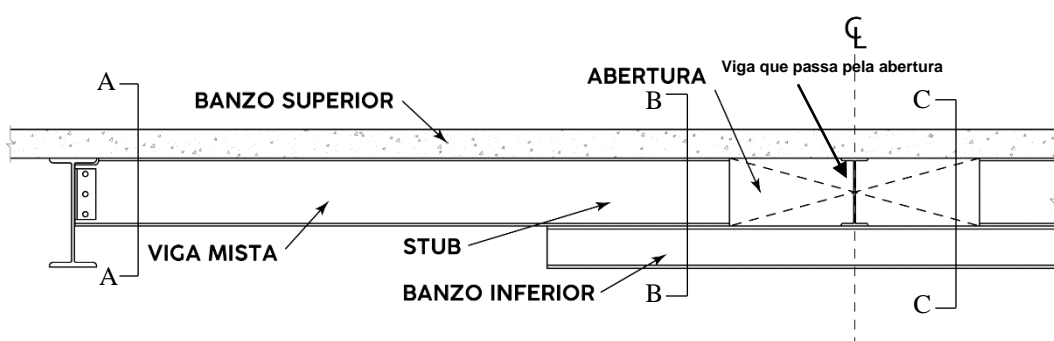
Sistema de pisos *Stub-Girder* modificado
